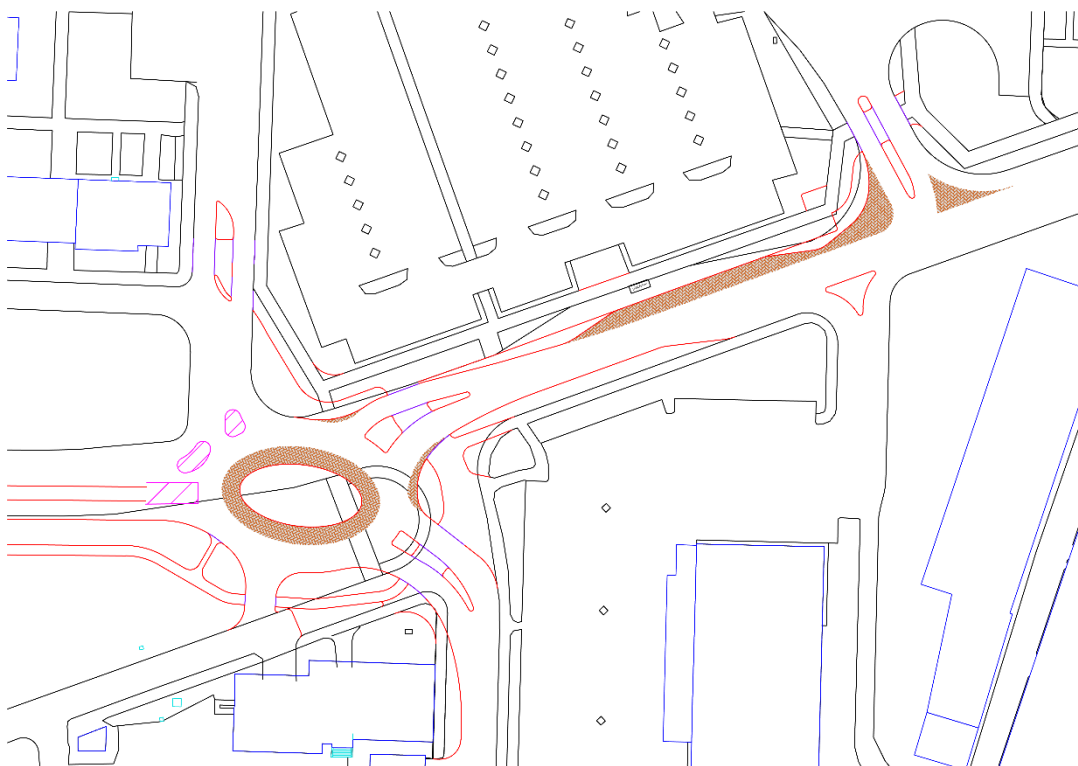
varianta 1 po fázi 1,2 výstavby
